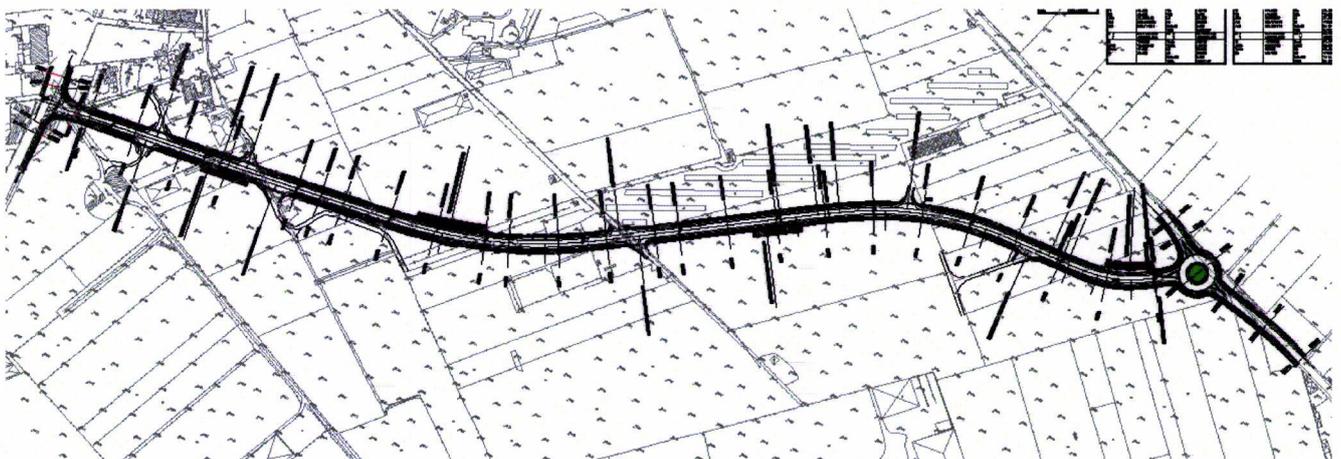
Stralcio planimetrico PD viabilità lato Est
